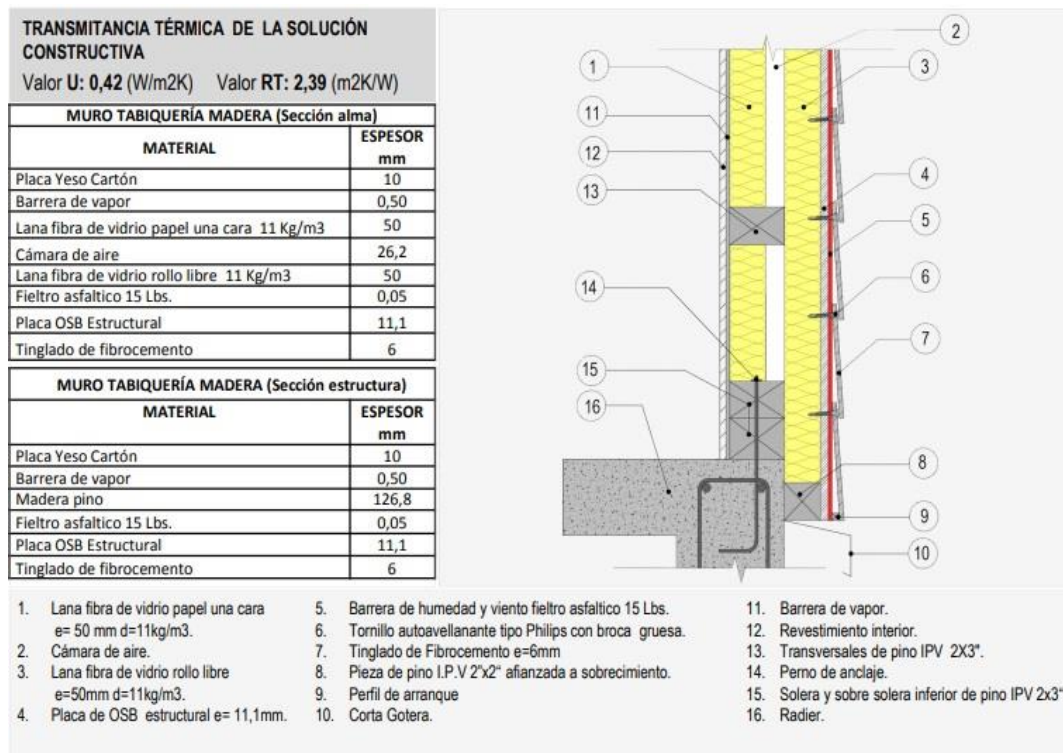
Detalle constructivo de la solución constructiva para muros Temuco. Fuente [9].
